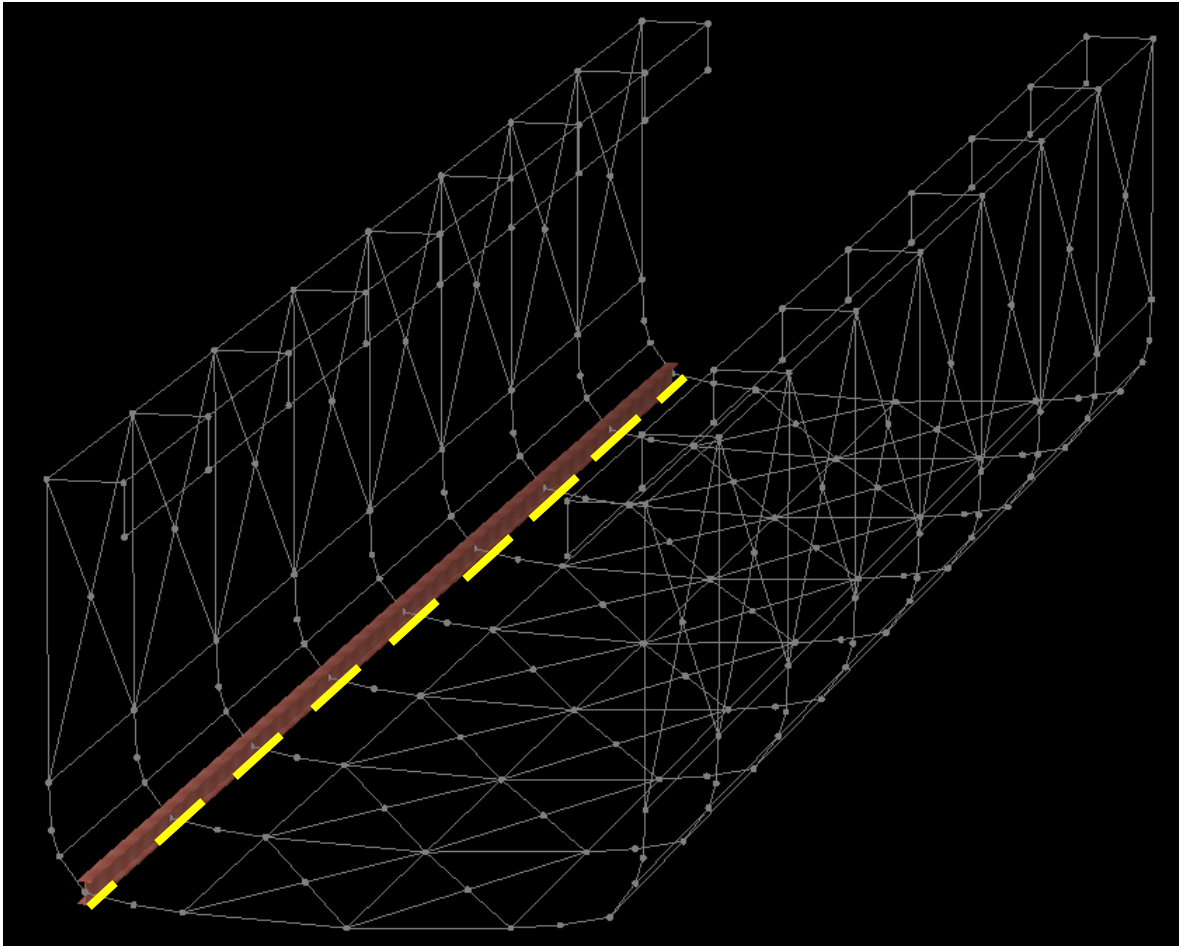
Reforzamiento longitudinal de anclajes soldado.
